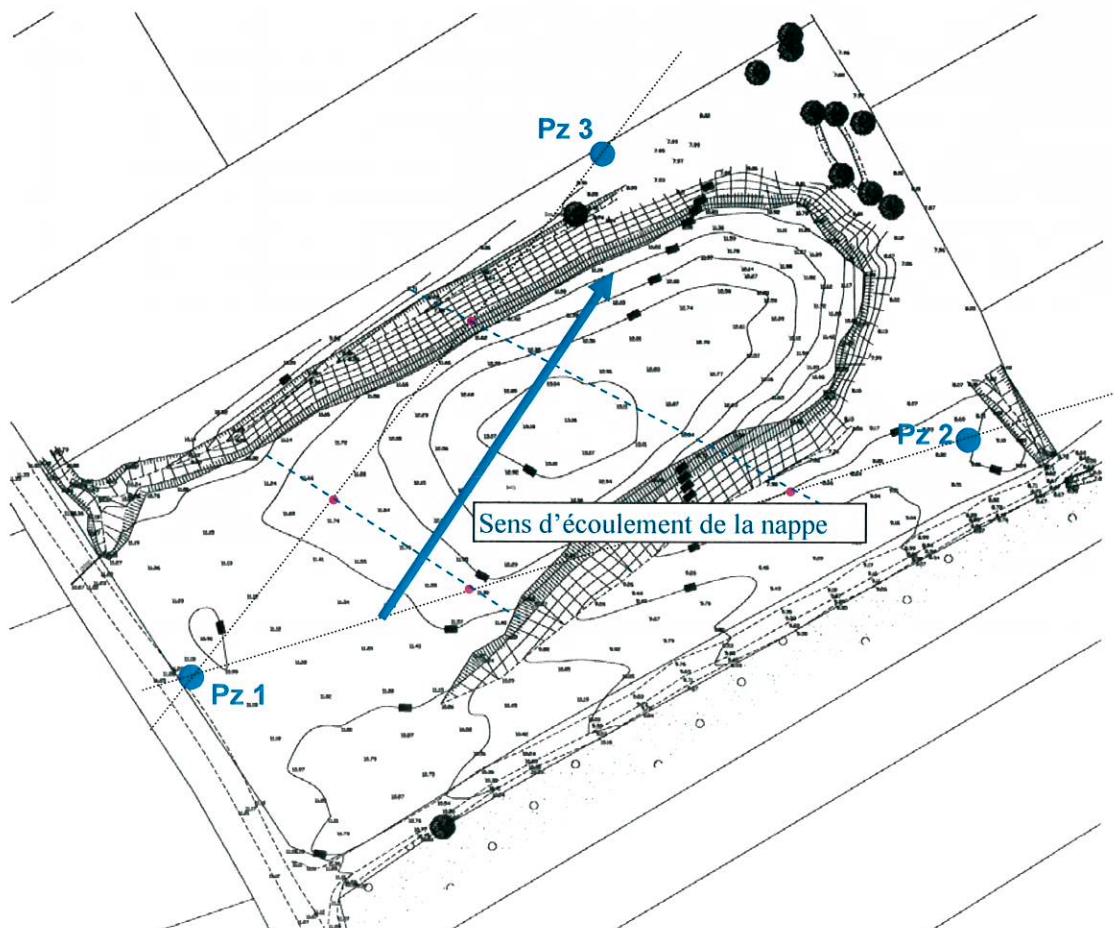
Sens d'écoulement de la nappe sur le site d'Avensan
